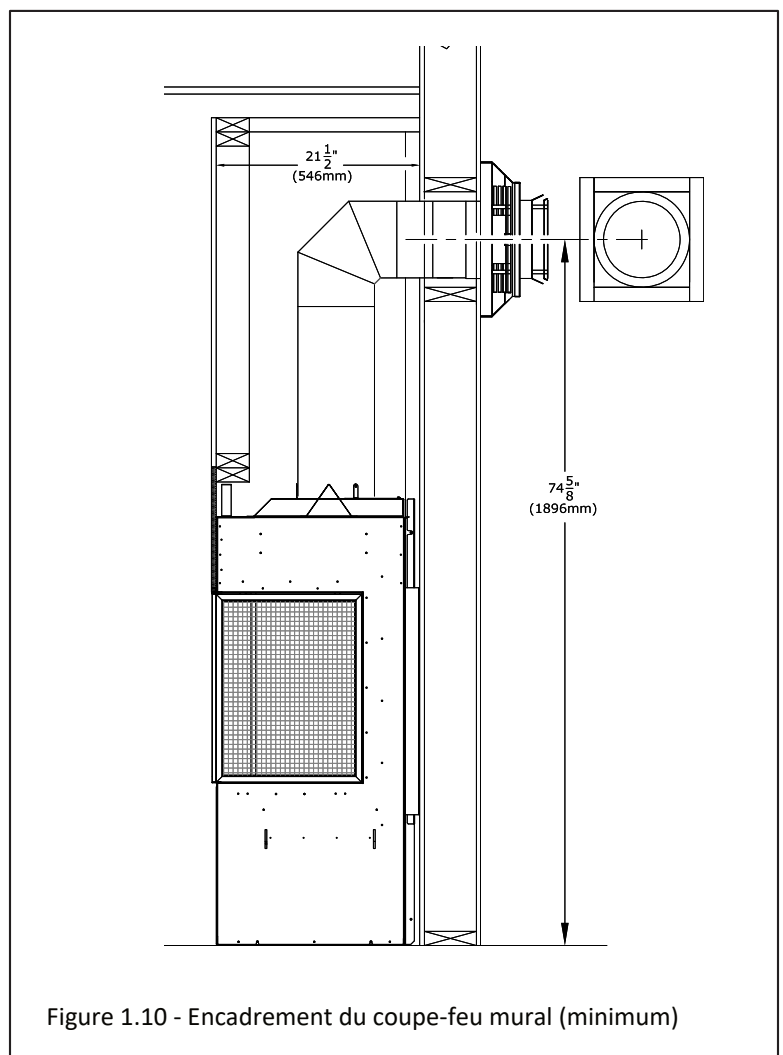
Encadrement du coupe-feu mural (minimum)
